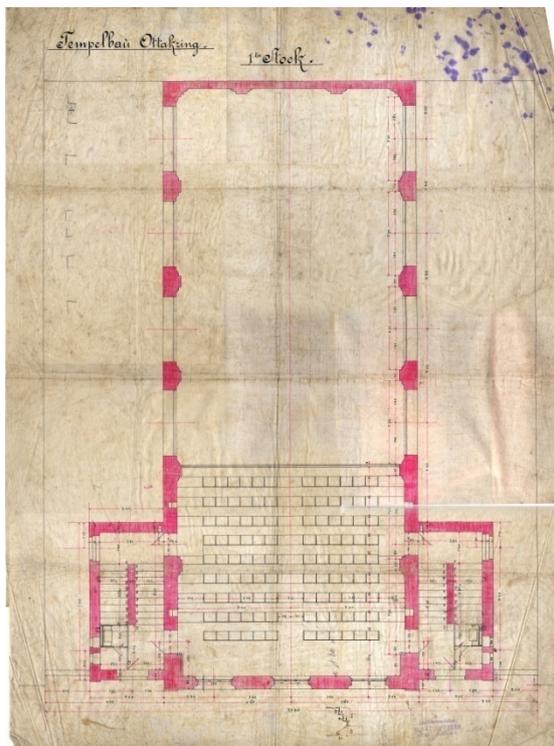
Grundriss 1.Stock für den Tempelbau Ottakring vor dem Erweiterungsbau
